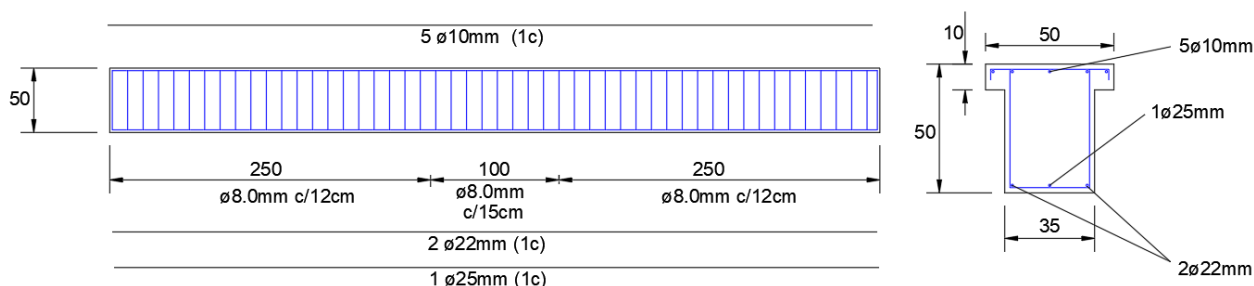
Características das vigas ensaiadas. Dimensões em cm (adaptado de WANG *et al.*, 2022)
